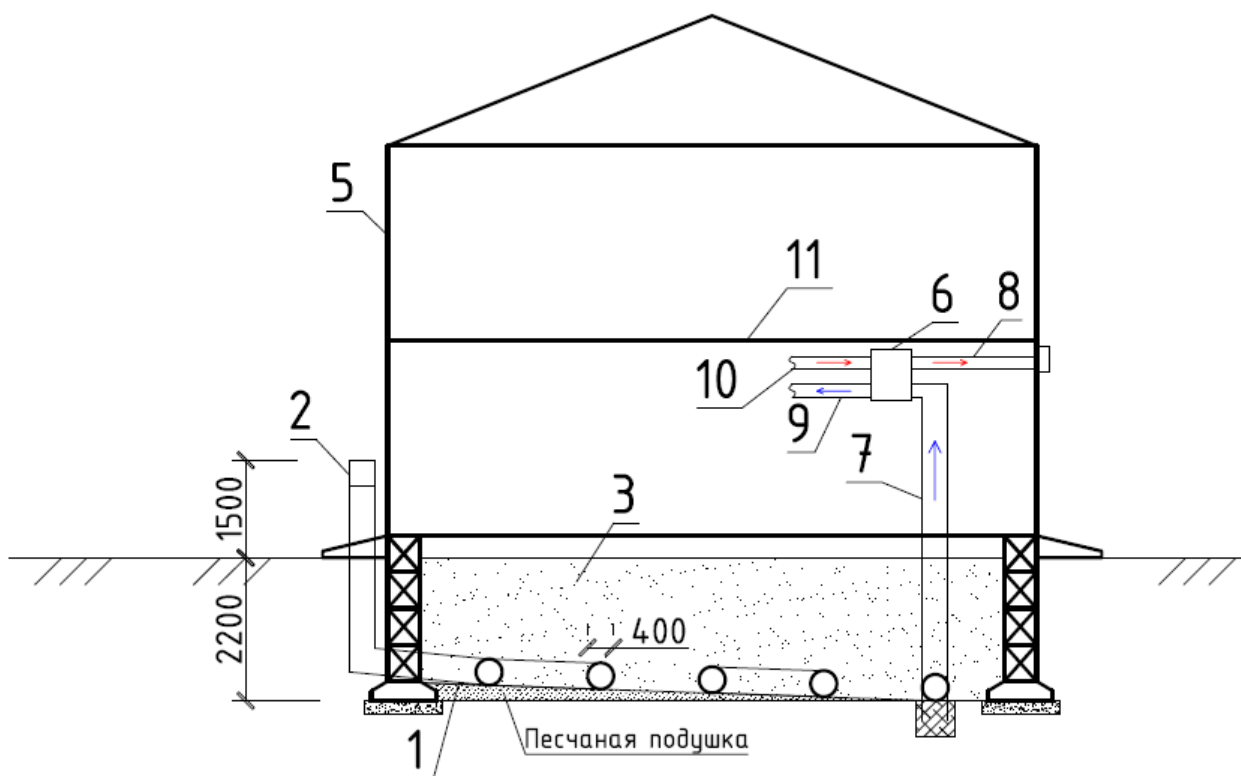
Теплогрунтообменник совместно с фундаментом здания, где: 1 – теплогрунтообменник; 2 – воздухозаборник; 3 – обратная засыпка; 4 – фундамент дома; 5 – частный дом; 6 – рекуператор; 7 – подача воздуха; 8 – выброс вытяжного воздуха; 9 – свежий приточный воздух; 10 – вытяжной воздух; 11 – уровень потолка 1 этажа дома
